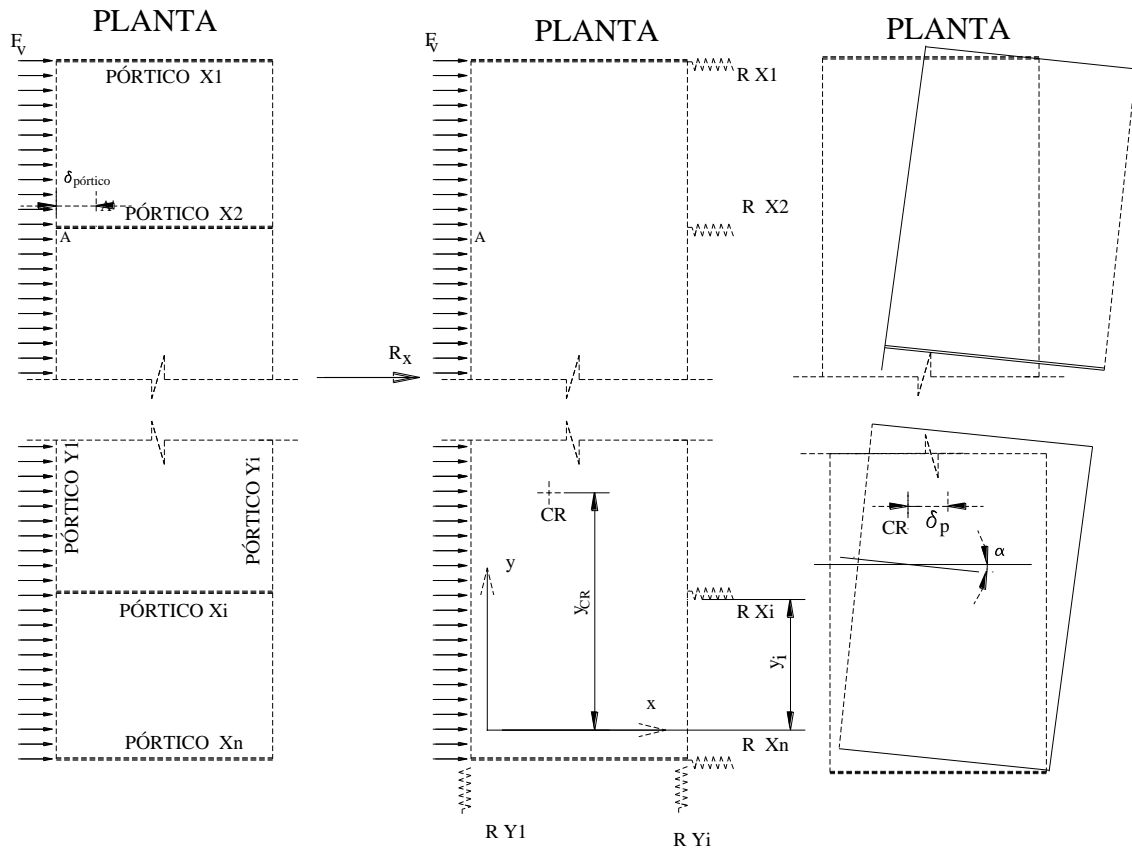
27 - Planta de pavimento contraventado por pórtico que podem ser substituídos por molas (figura central) e que apresentará um movimento de corpo rígido, transladando e girando em relação ao centro de rigidez.
